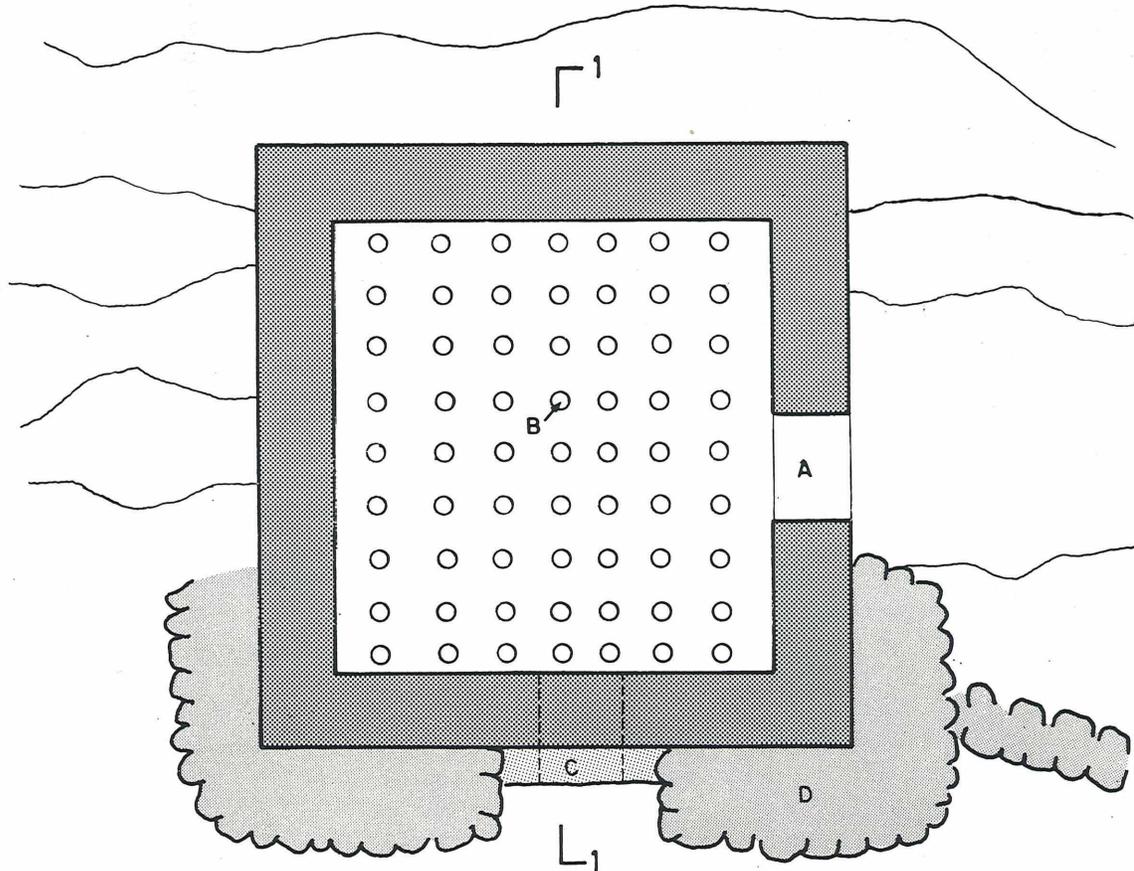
Planta de una tejera a nivel de la parrilla (Tejera nº 1, Vélez-Blanco). A.- Puerta de la cámara de cocción, B.- Arquetas. C.- Puerta de la cámara de fuego. D.- Refuerzos.
